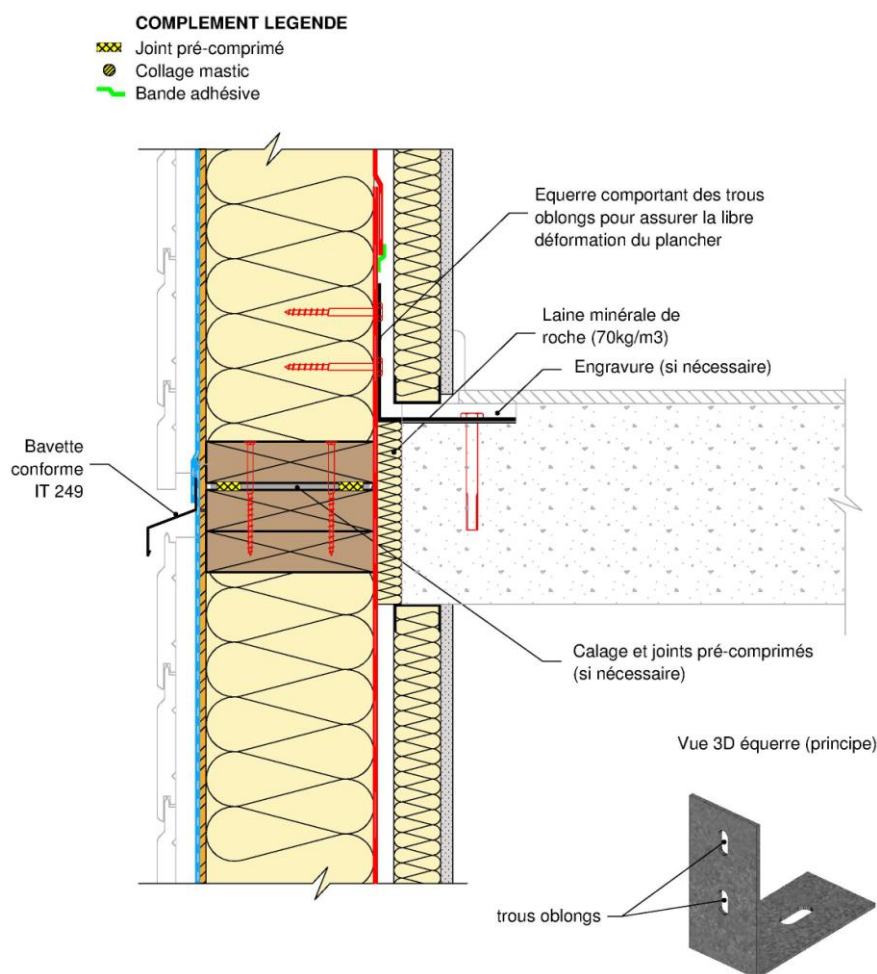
Principe de façade filante autoportante – Coupe verticale en nez de dalle
